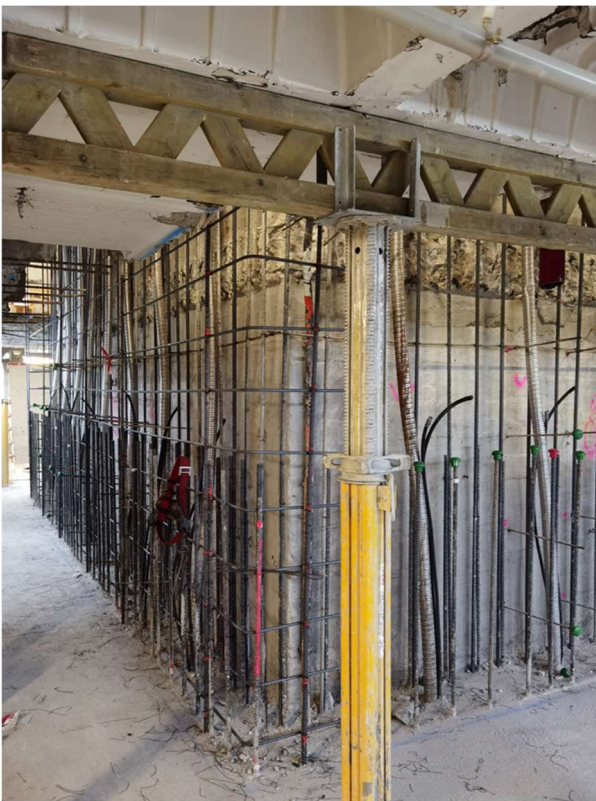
Fase de apeo y colocación de armado pasivo en refuerzo de núcleos.
